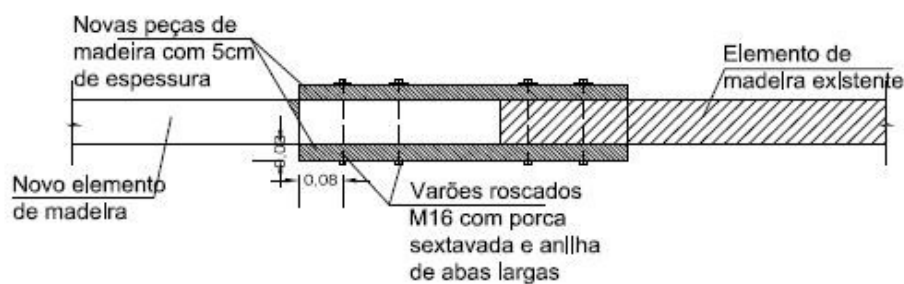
Exemplo de introdução de novos elementos para substituir elementos degradados (em planta).
